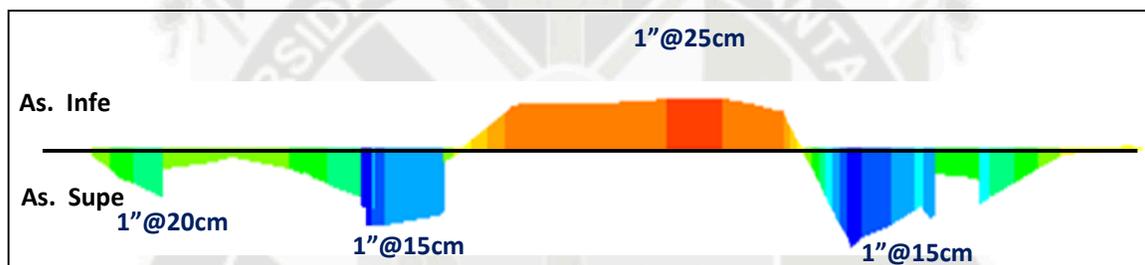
Refuerzo Superior e Inferior en la Dirección y-y de la Platea.
